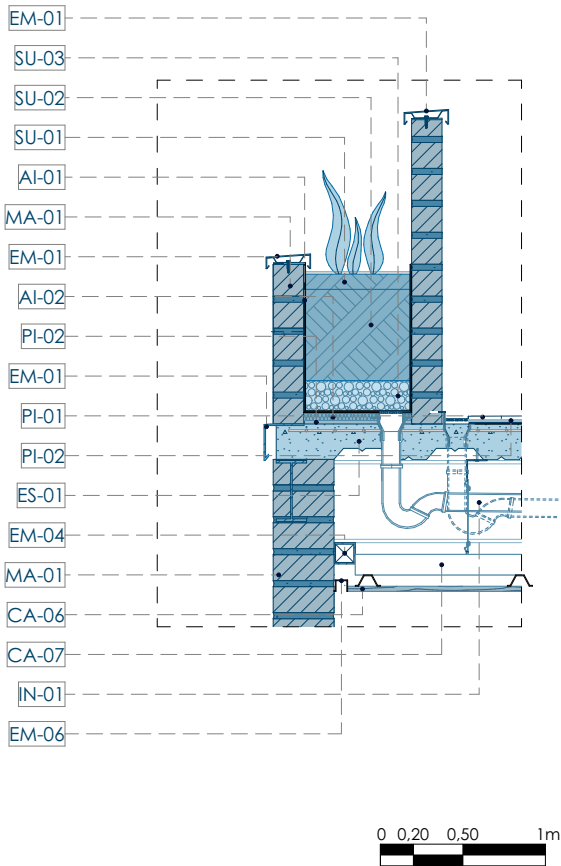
Detalle constructivo 01. Nota. Elaboración propia.
